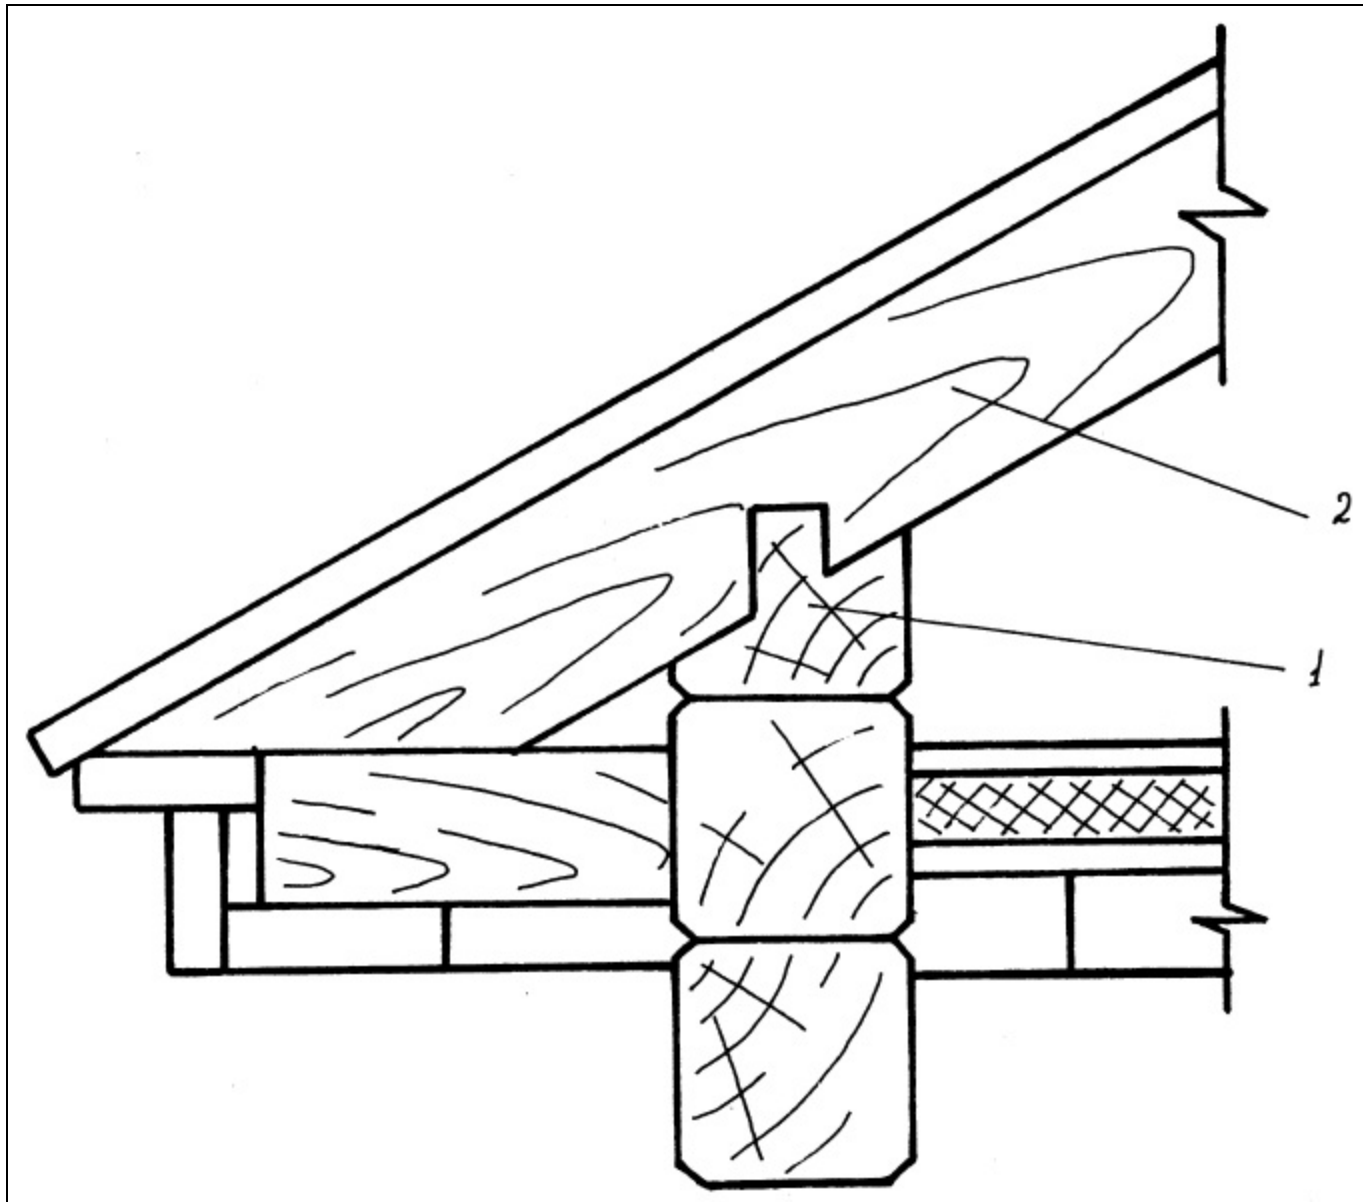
Наслонные стропила: 1 – стропильная нога; 2 – ригель; 3 – чердачное перекрытие.
